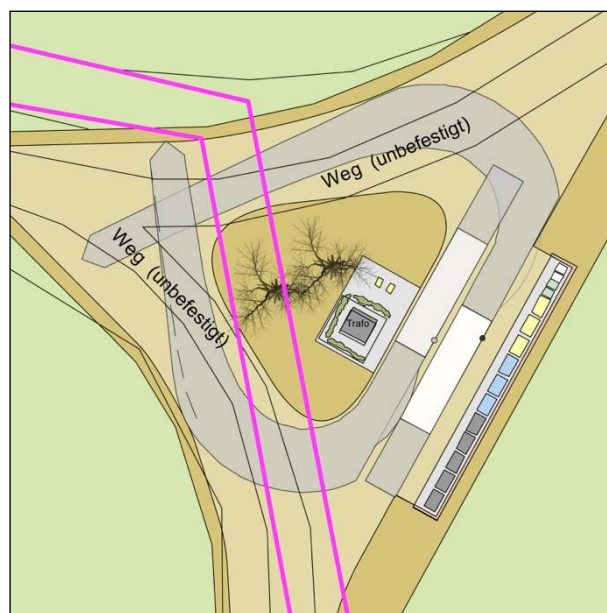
Fläche für Müll- und Wertstoffcontainer Entwurfsvariante 2 (Stand 05/2016)
